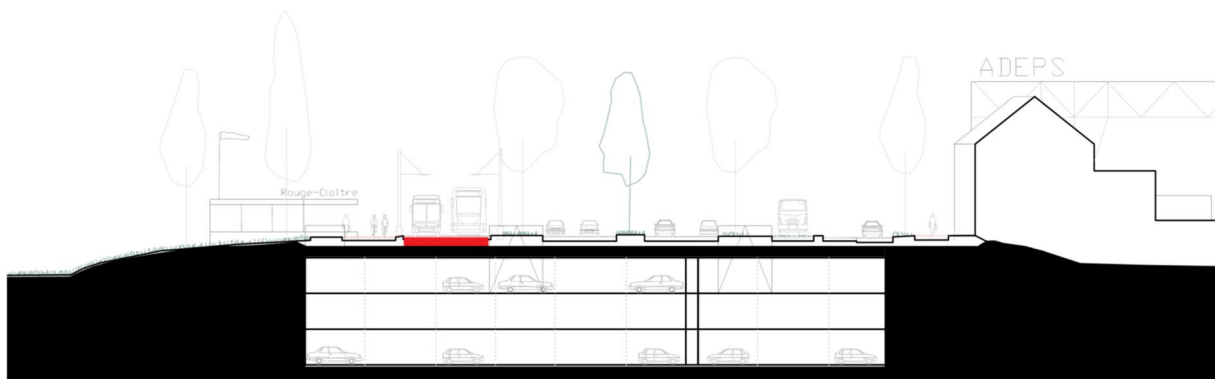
Coupe à travers le P+R sur le site Stade-Adeps (ORG², 2018)
